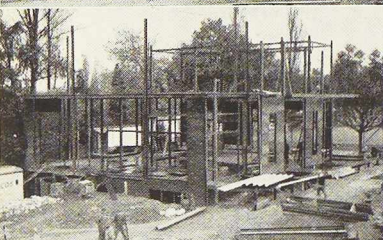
Le 25 octobre 1937, le montage de l'ossature de la toiture est commencé. Les revêtements en tôles Am'Acier du rez-de-chaussée sont en cours de fixation.
